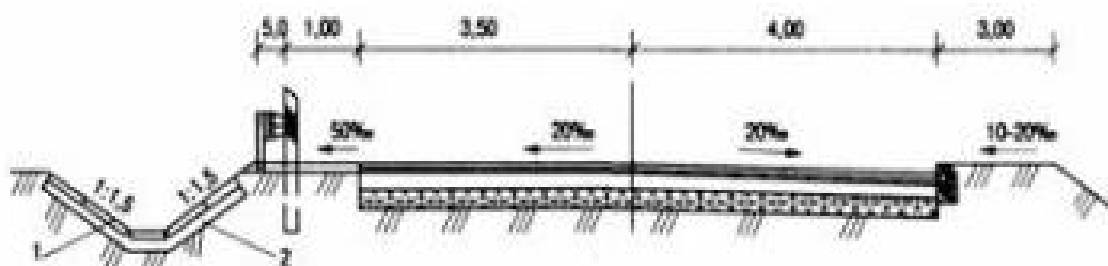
Система организации поверхностного (открытого) водоотвода на автомобильной дороге: 1 – бетонная плитка 10×60×10 см; 2 – бетонная подушка
